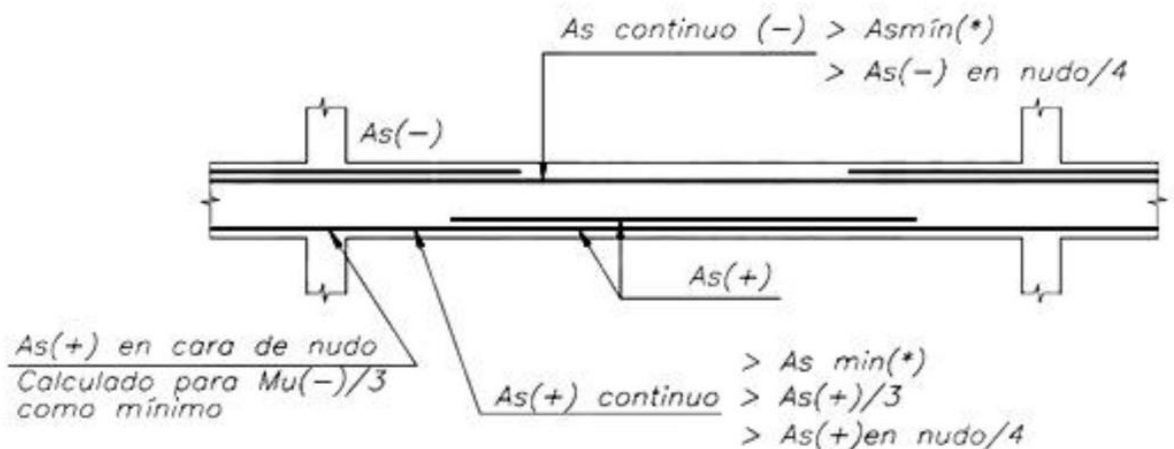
5 Distribución de refuerzo longitudinal en vigas
